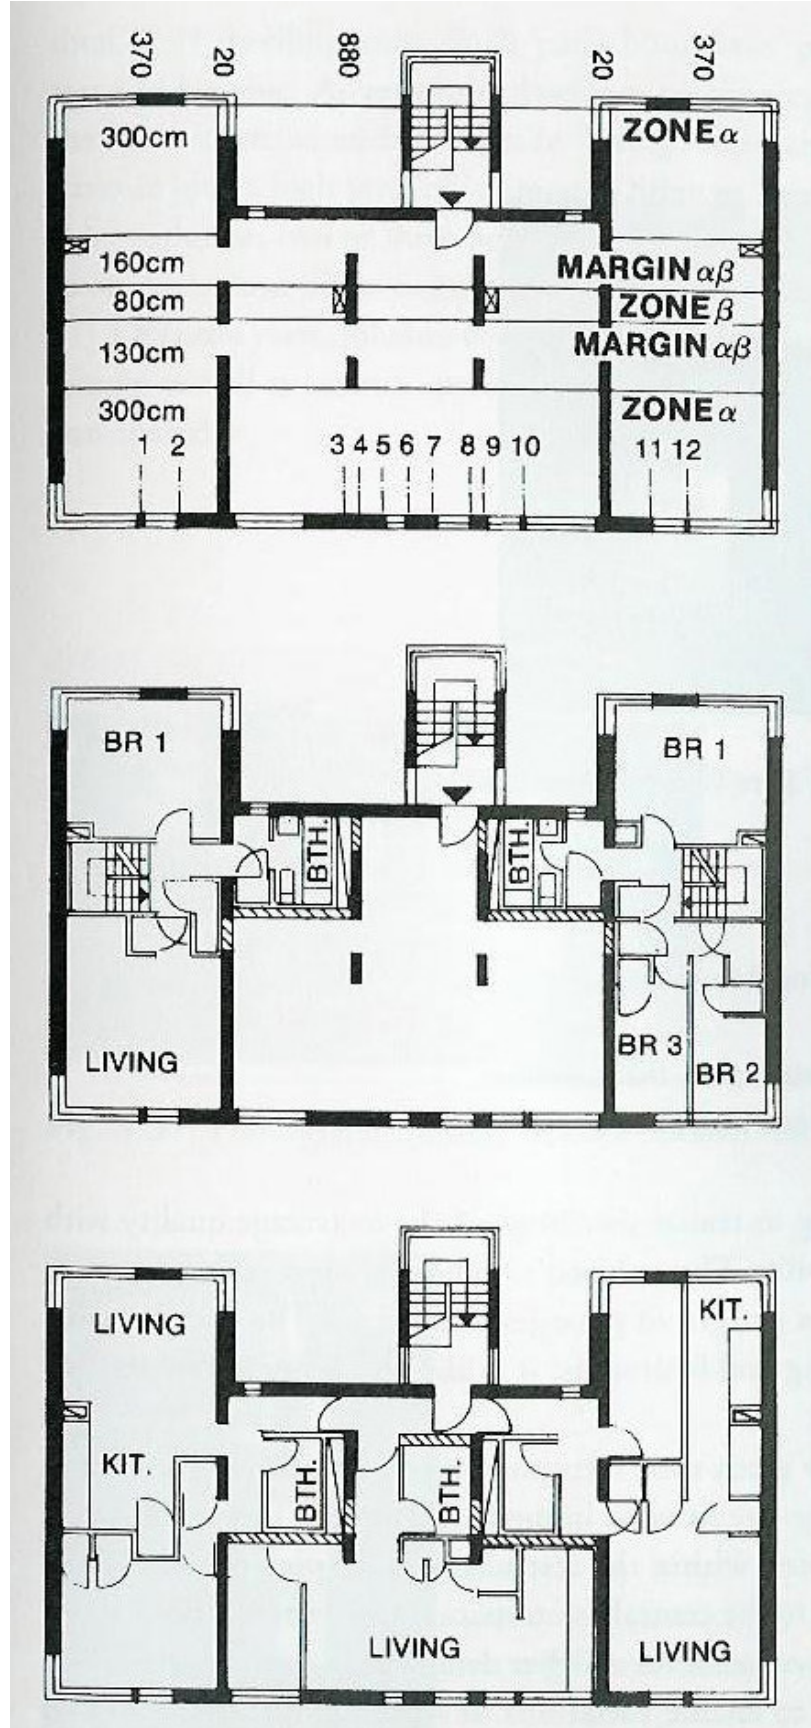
PSSHAK / Adelaide Yolu Vaziyet Planı (Kendall, Teicher, 2000)
